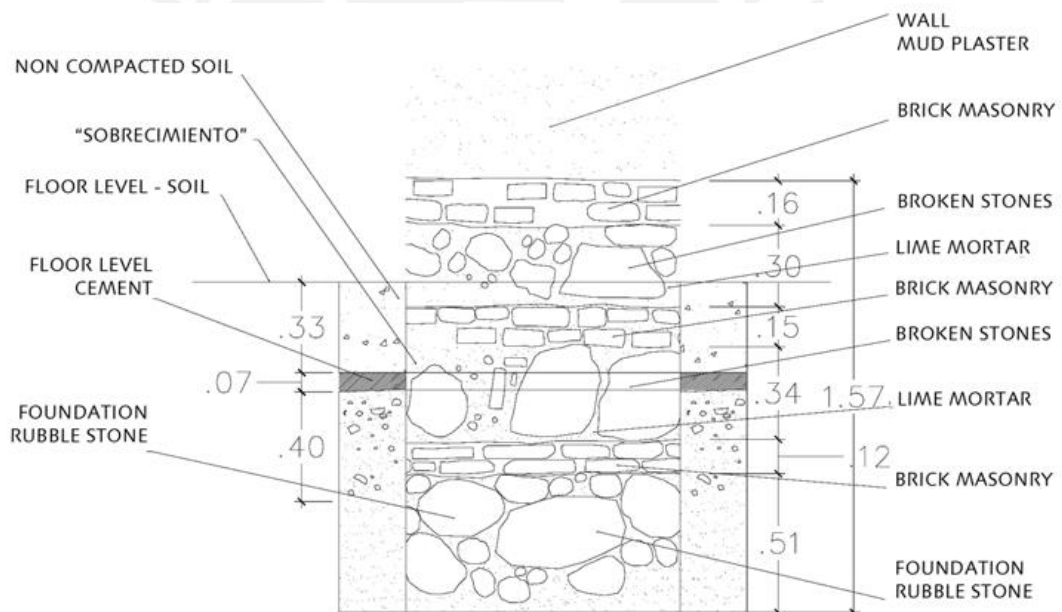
Corte transversal de la cimentación y sobrecimiento [1]
